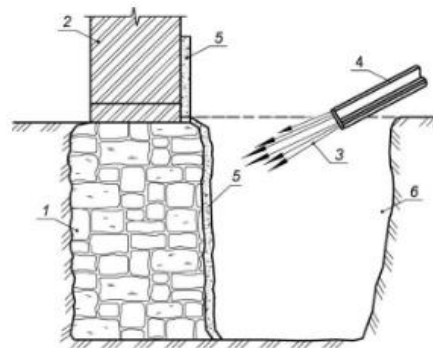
Восстановление несущей способности фундаментов путем закрепления кирпичной и бутовой кладки торкрет – бетоном: 1 – существующий фундамент, имеющий расслоение кладки; 2 – кирпичная стена с разрушенным поверхностным слоем; 3 – набрызг бетонной смеси под высоким давлением; 4 – цемент-пушка (или бетон-шприц-машина); 5 – торкретируемая поверхность
